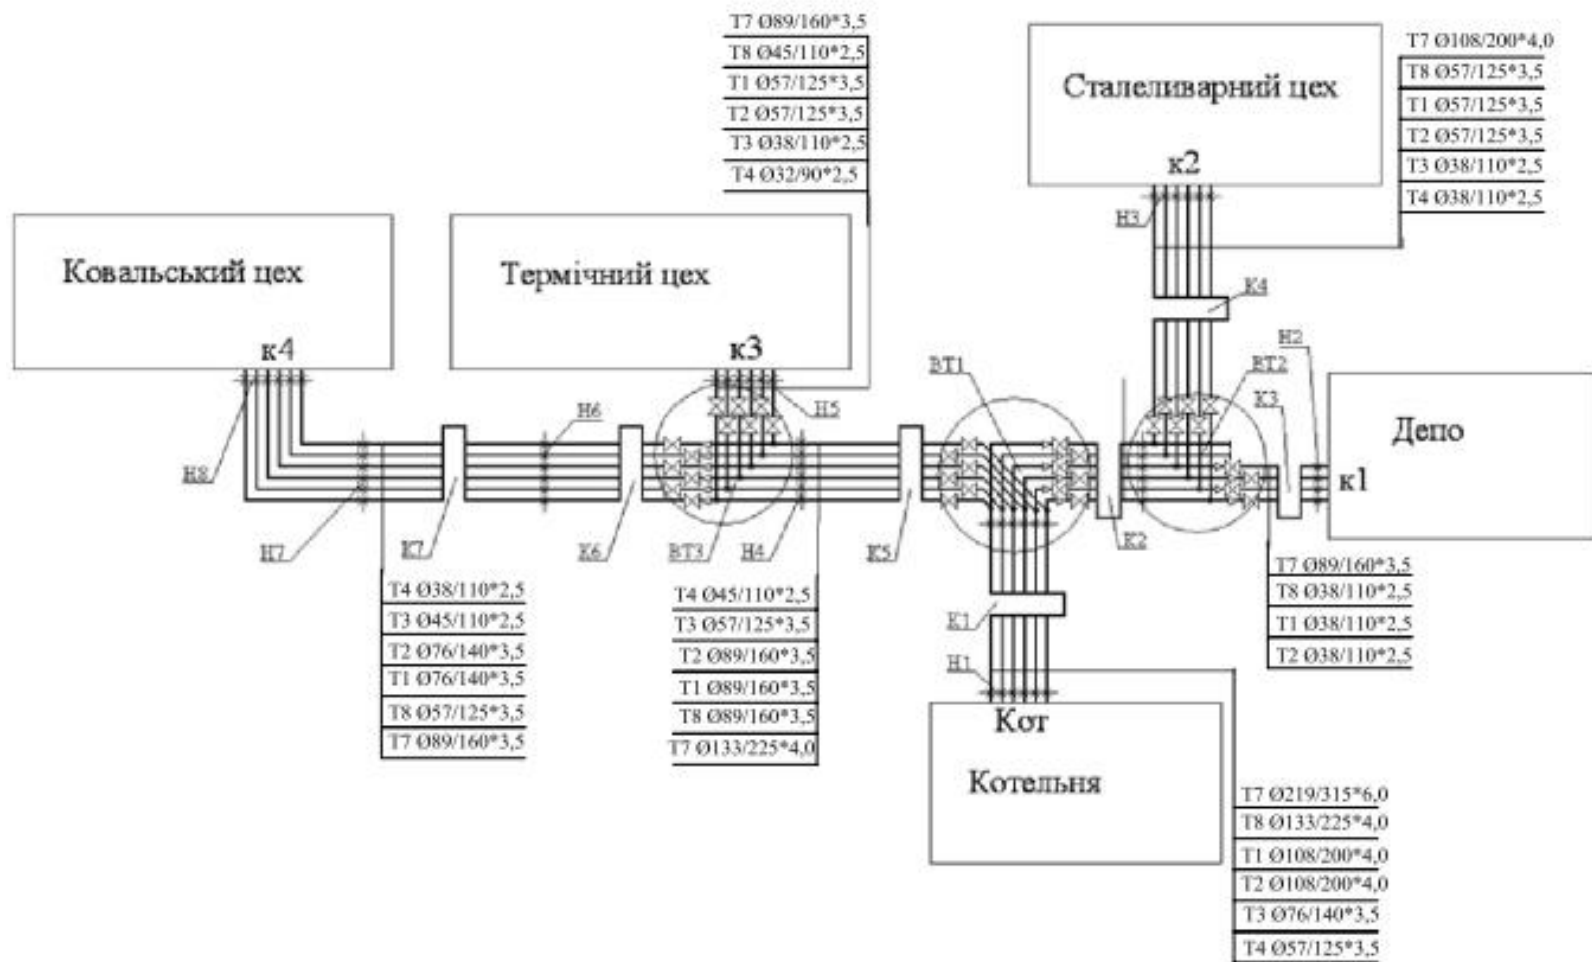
Приклад монтажної схеми для систем теплопостачання, розрахованих у розділі 9
